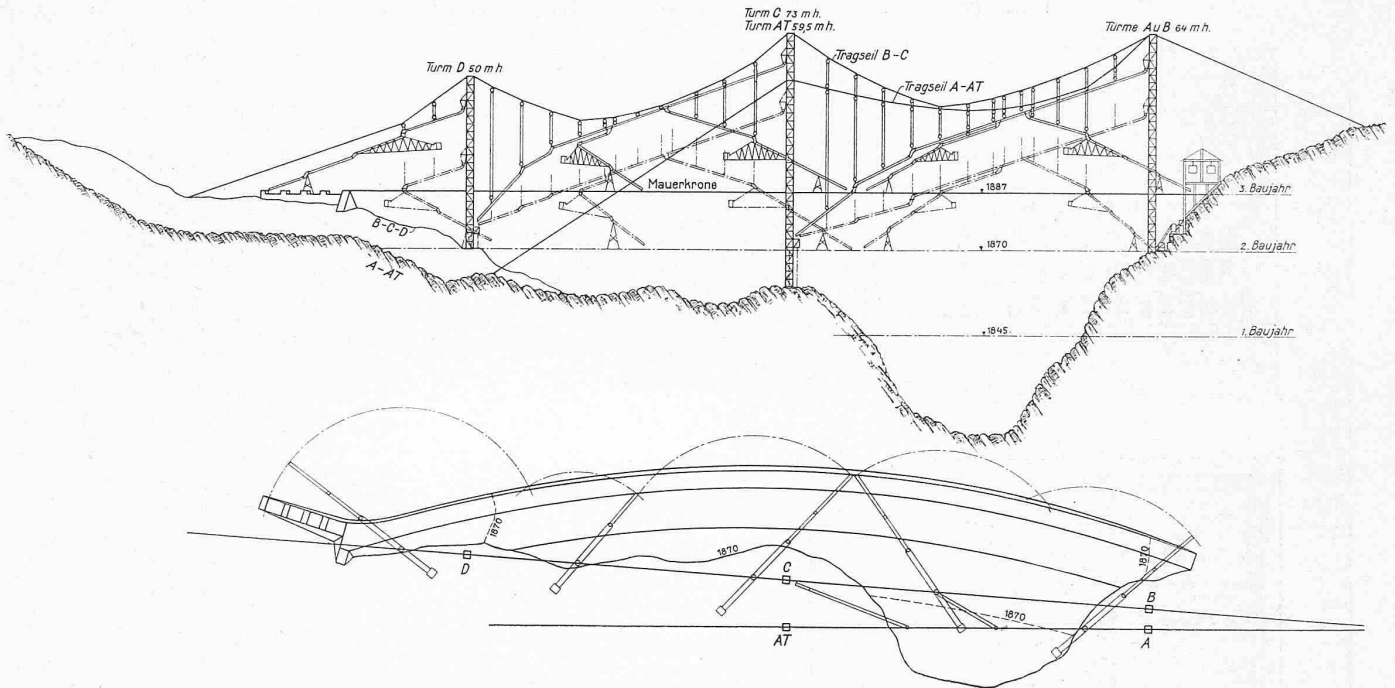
Grundriss und Ansicht im Vollausbau, für Betonierung bis auf Stauwandkrone auf 1887 m ü. M. — Masstab 1:2000.
